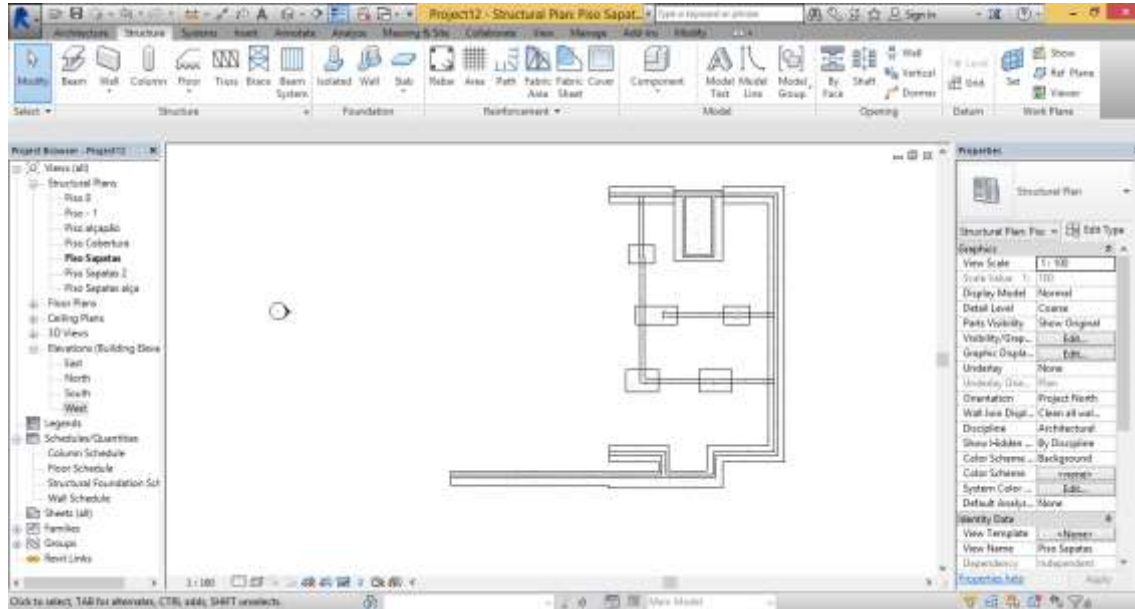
Planta de sapatas e lintéis da fundação do piso -1
